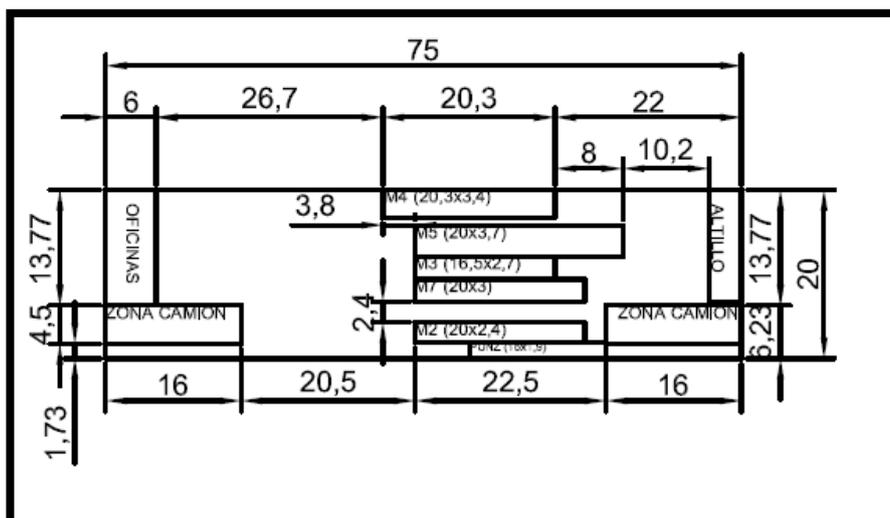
Plano de situación de la fábrica. Fuente: Perfiles Blanco.
